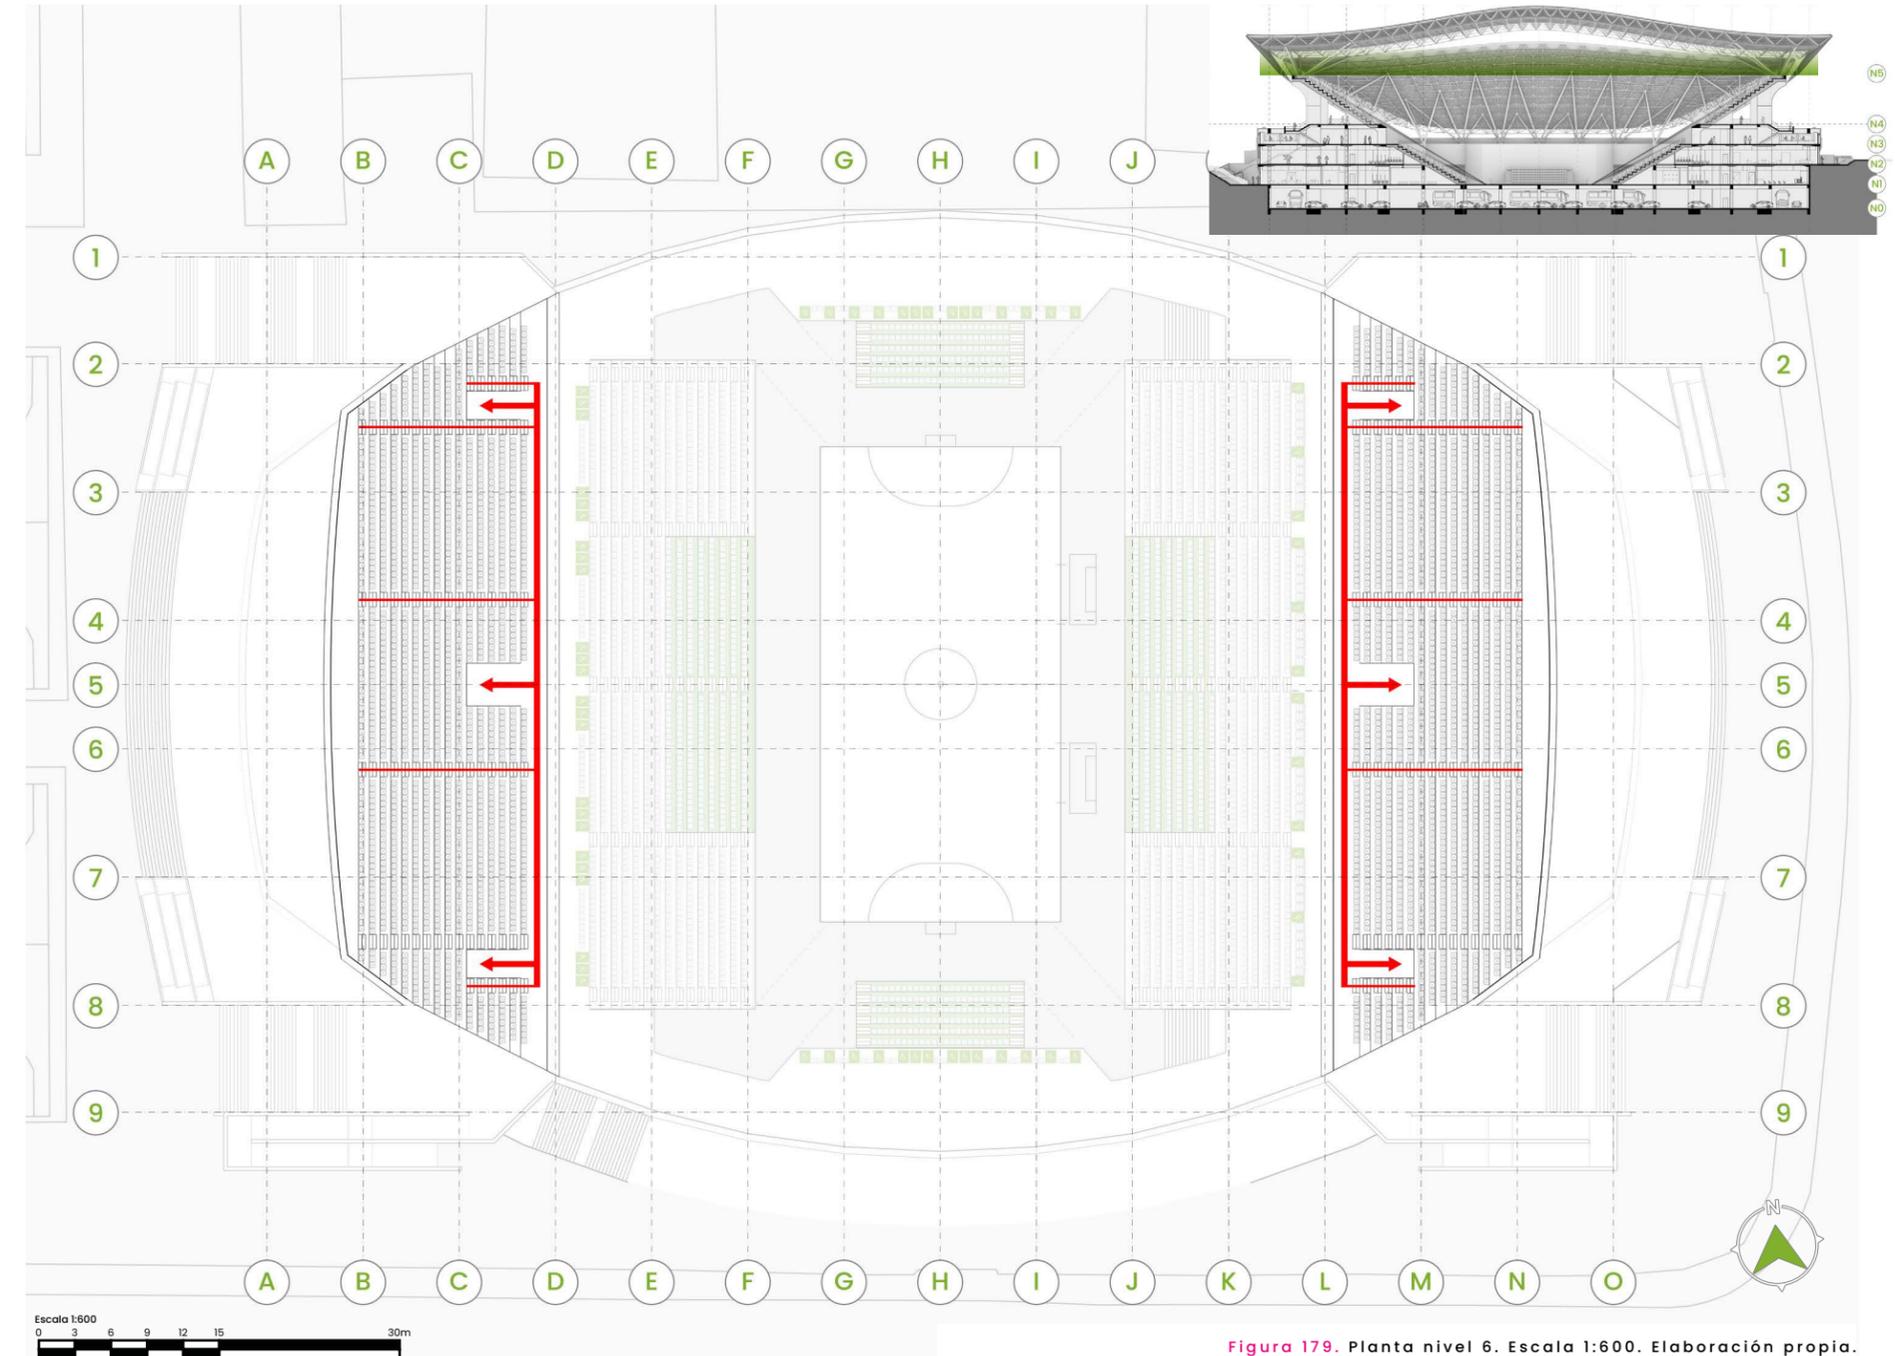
Planta nivel 6. Escala 1:600. Elaboración propia.
